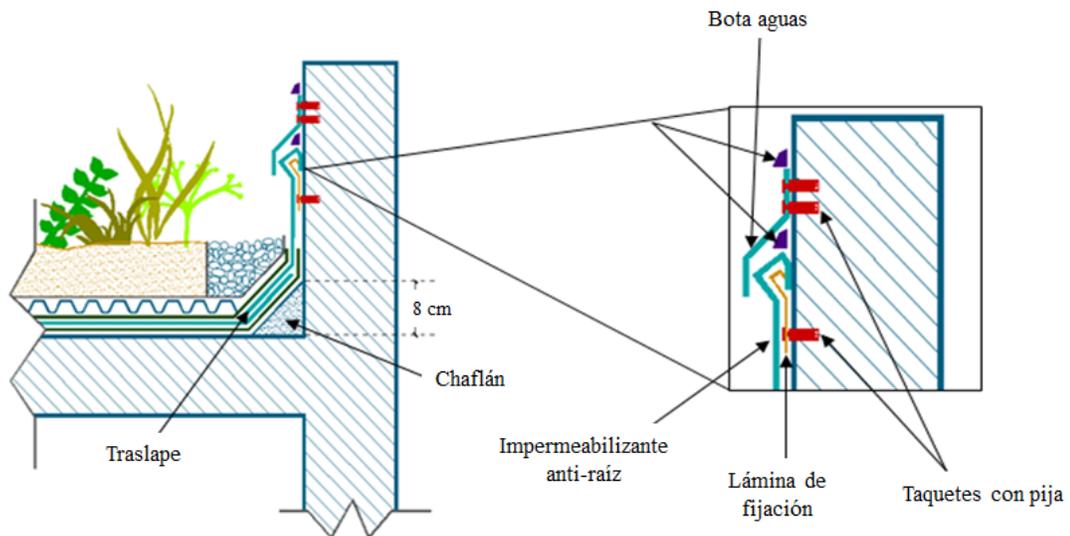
Impermeabilización con láminas de PVC, propileno-etileno o similares en puntos de encuentro con pretilas y elementos emergentes perimetrales.
